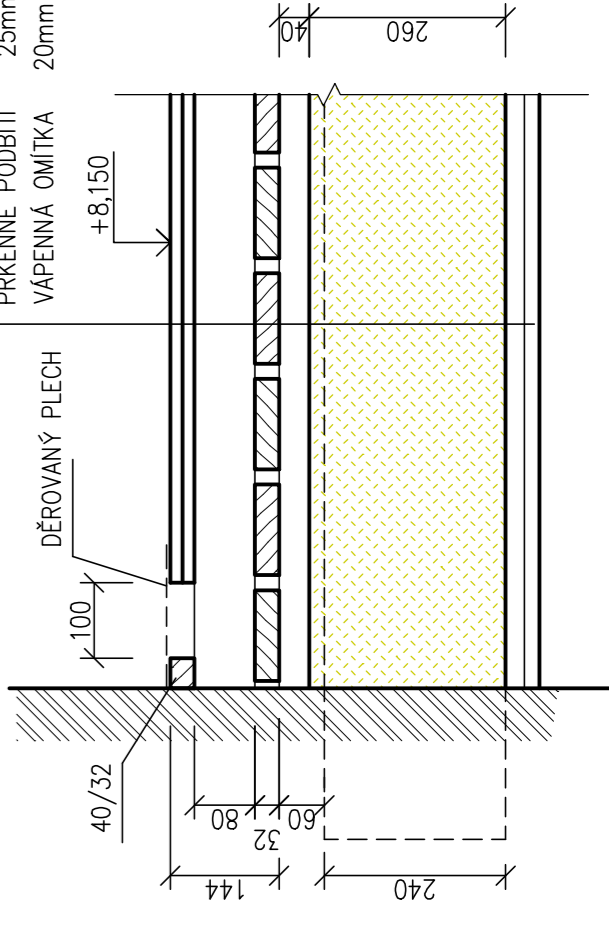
DETAIL NÁHRADY STROPNÍHO TRÁMU:
